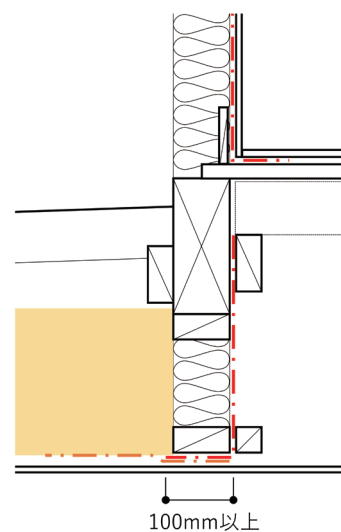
下屋部分の先張り防湿フィルムの施工例
